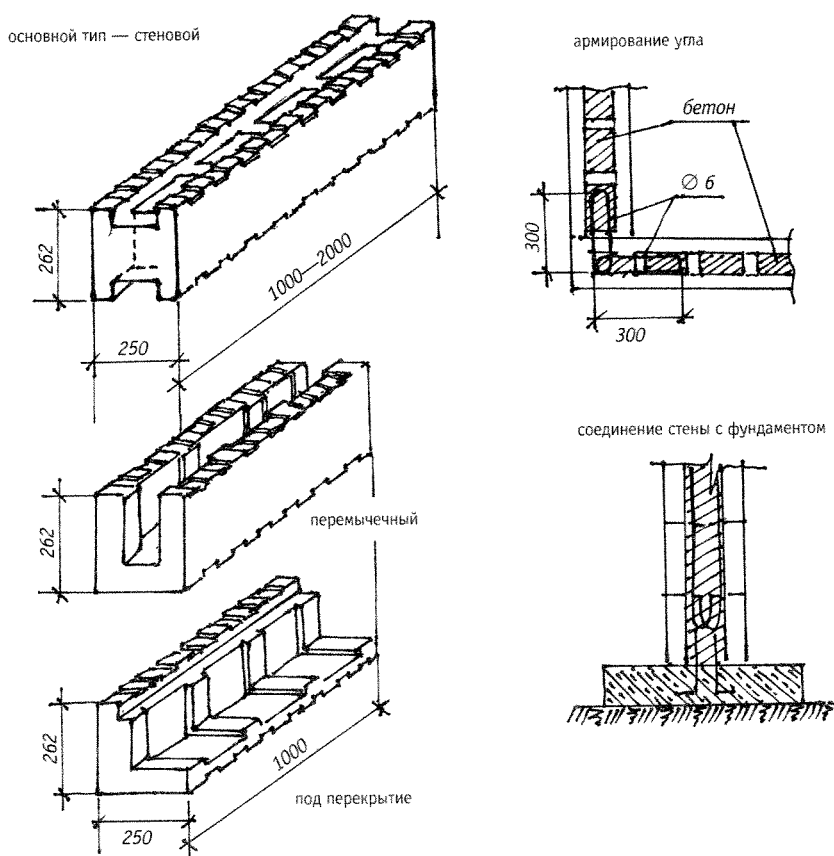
Элементы несъемной опалубки из пенополистирольных блоков
